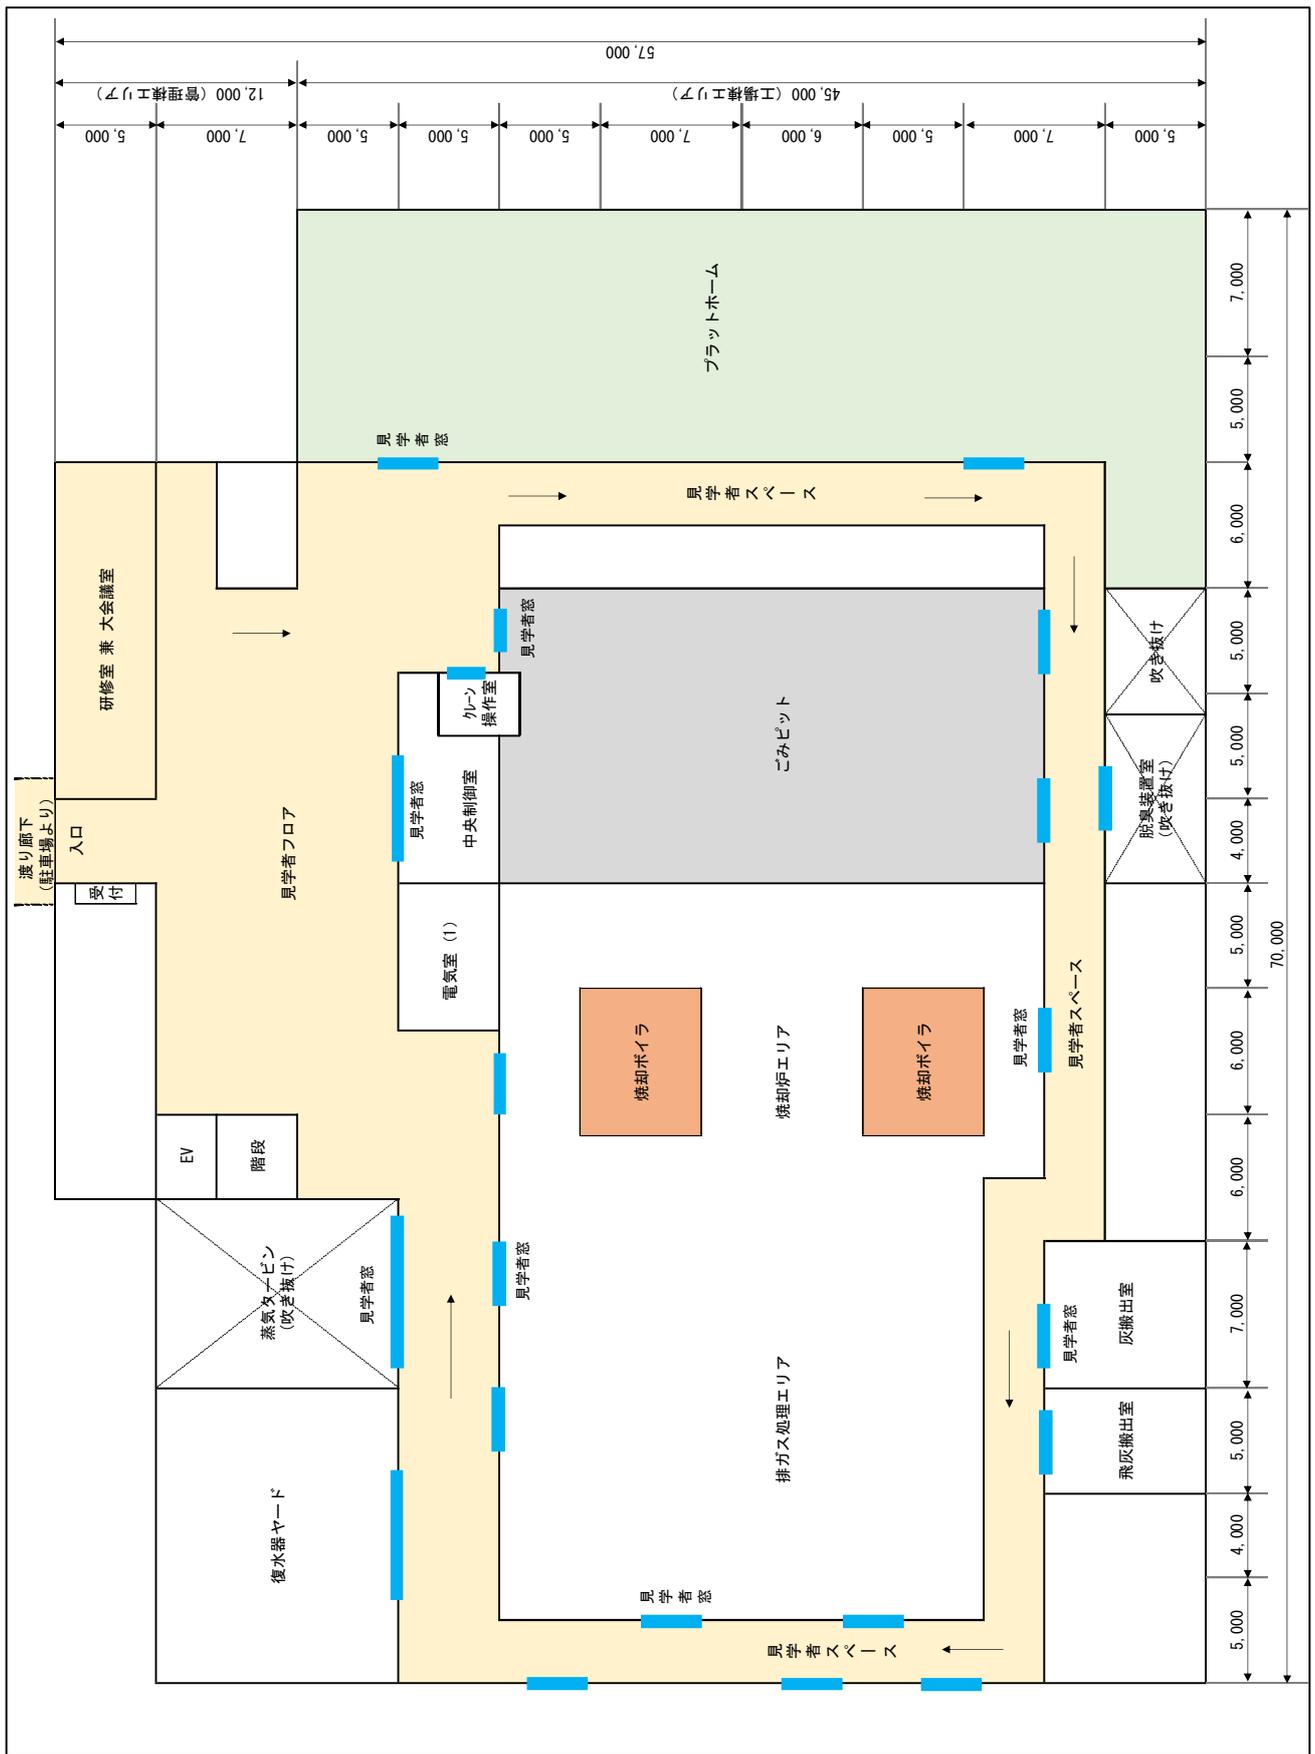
(2) 計画施設の平面図 (FL+6,000)
